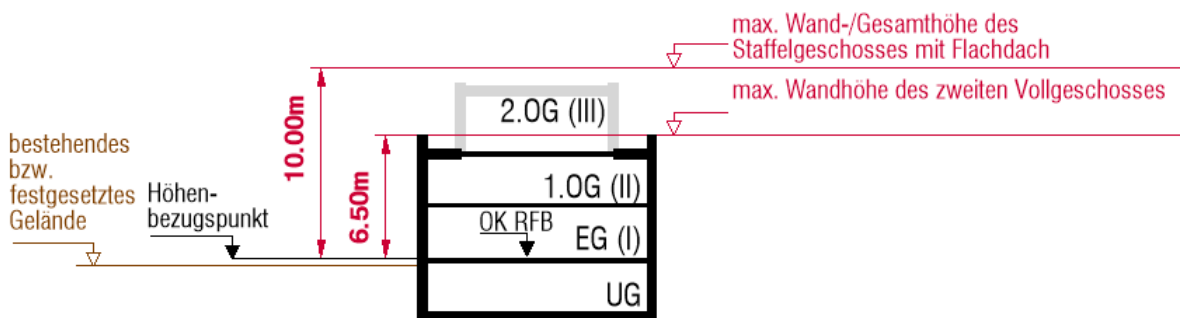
Beispielhafte Systemskizze für ein zurückversetztes Staffelgeschoss mit Flachdach im WA 2, o. M.
